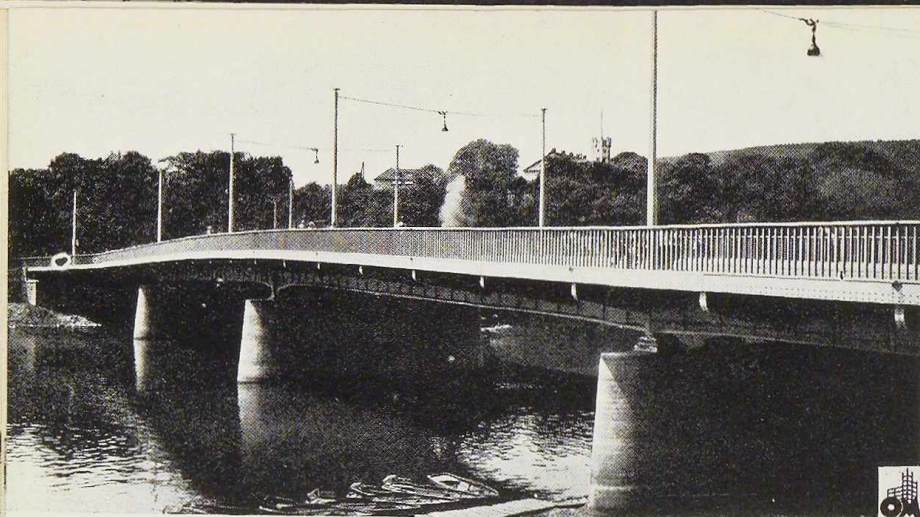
Pont à poutres continues sur la Ruhr à Werden.
